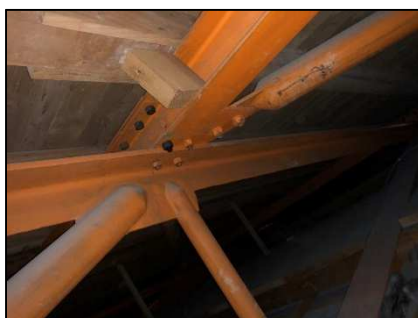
Ansicht Verbindungsknoten Dach, Wind-Verbände aus Stahlrohren
